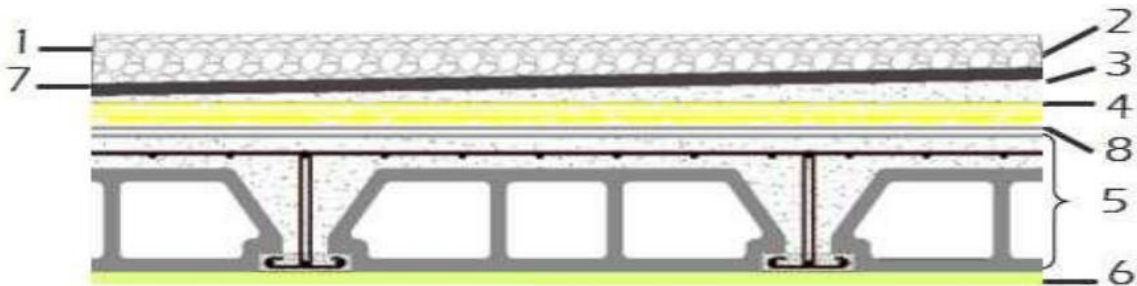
Les éléments qui constituent un plancher corps creux inaccessible.
